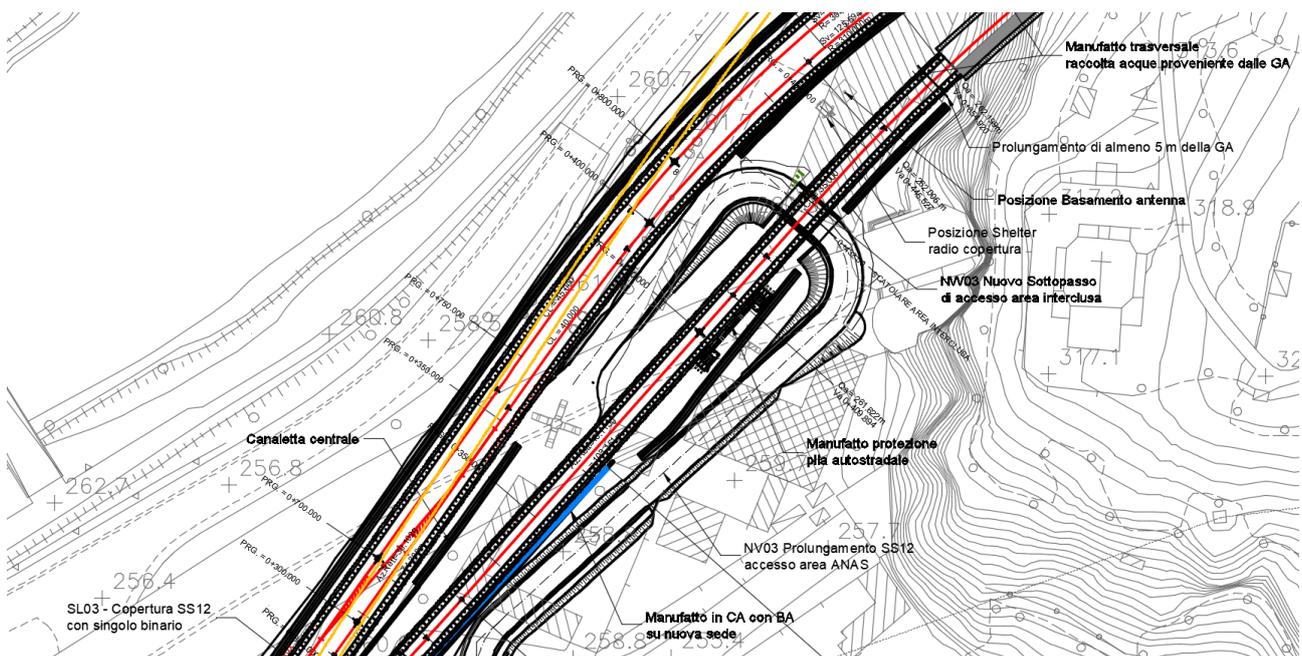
Stralcio planimetria delle opere che interessano l'area ex ANAS
